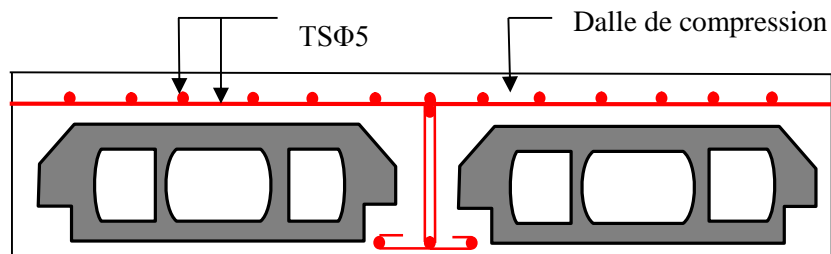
Schéma de ferrailage de la dalle de compression.
